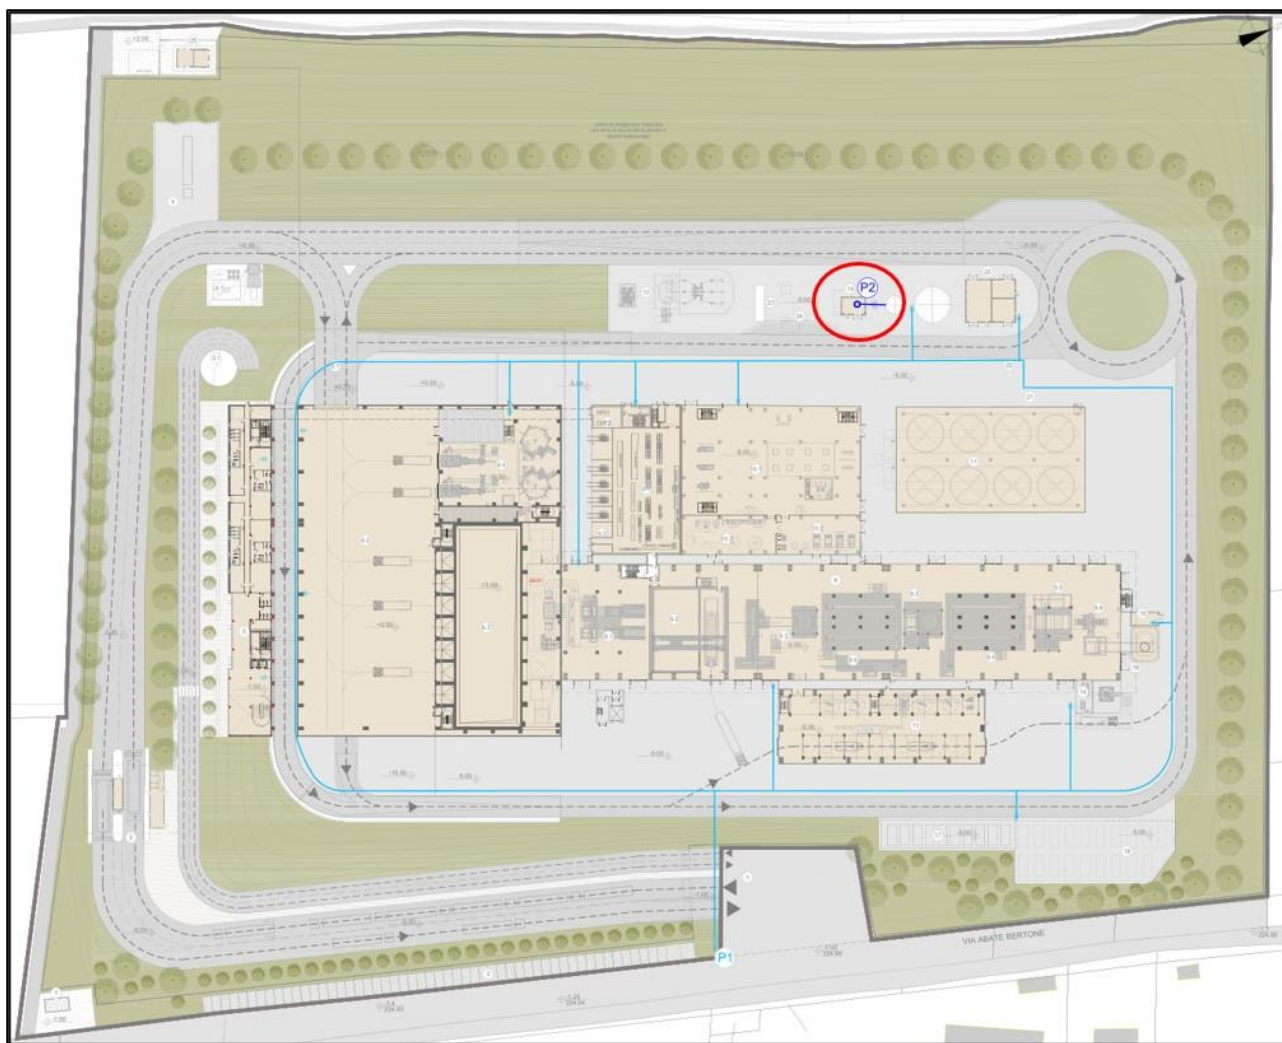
Planimetria con la rete di approvvigionamento idrico dell'impianto. Il pozzo di nuova realizzazione è quello indicato con la sigla P2 (Fonte: CAVP09O10000GAA0600401\_SIA).
